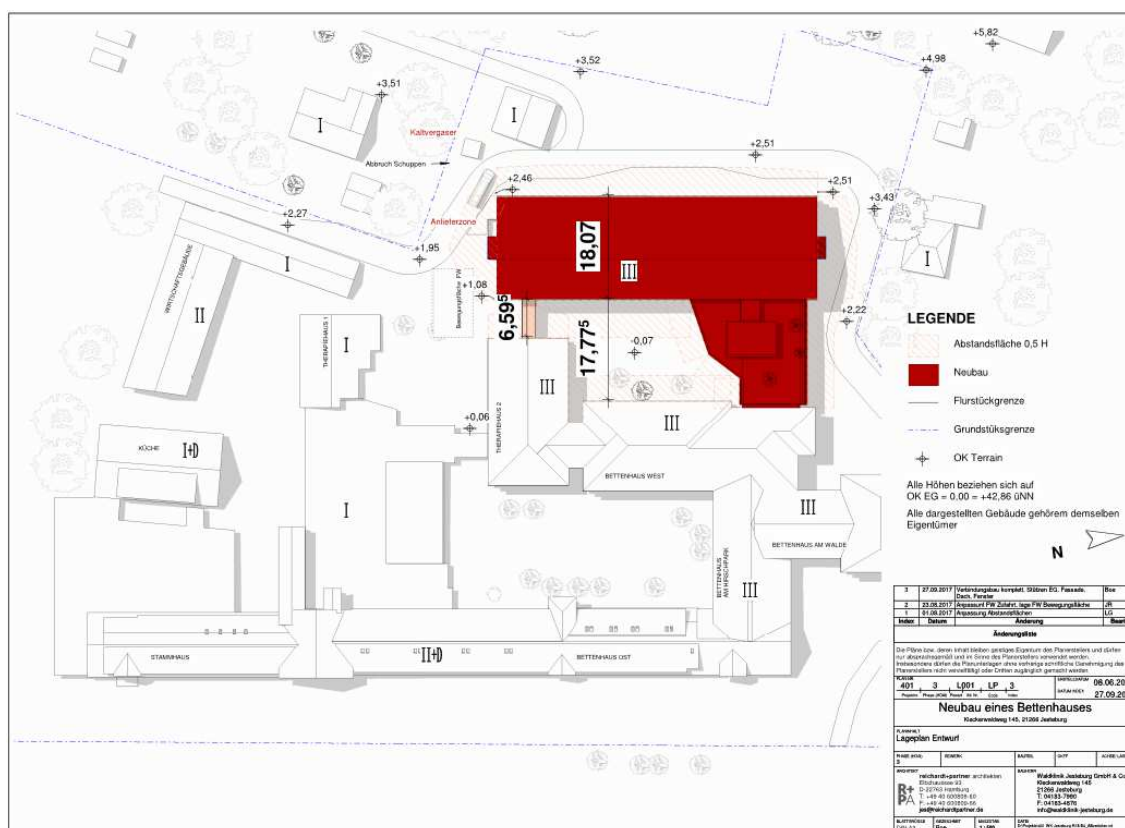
Lageplan Walklinik Jesteburg [32]
